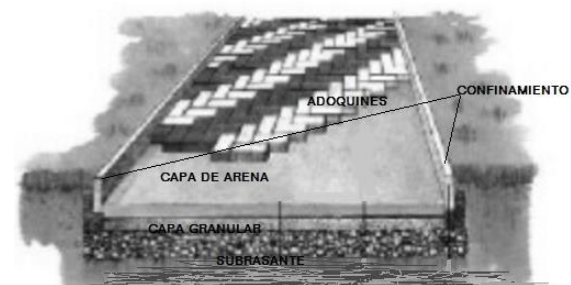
Estructura de un pavimento articulado. Fuente: S. F. Sandoval Sarmiento. (2009).
